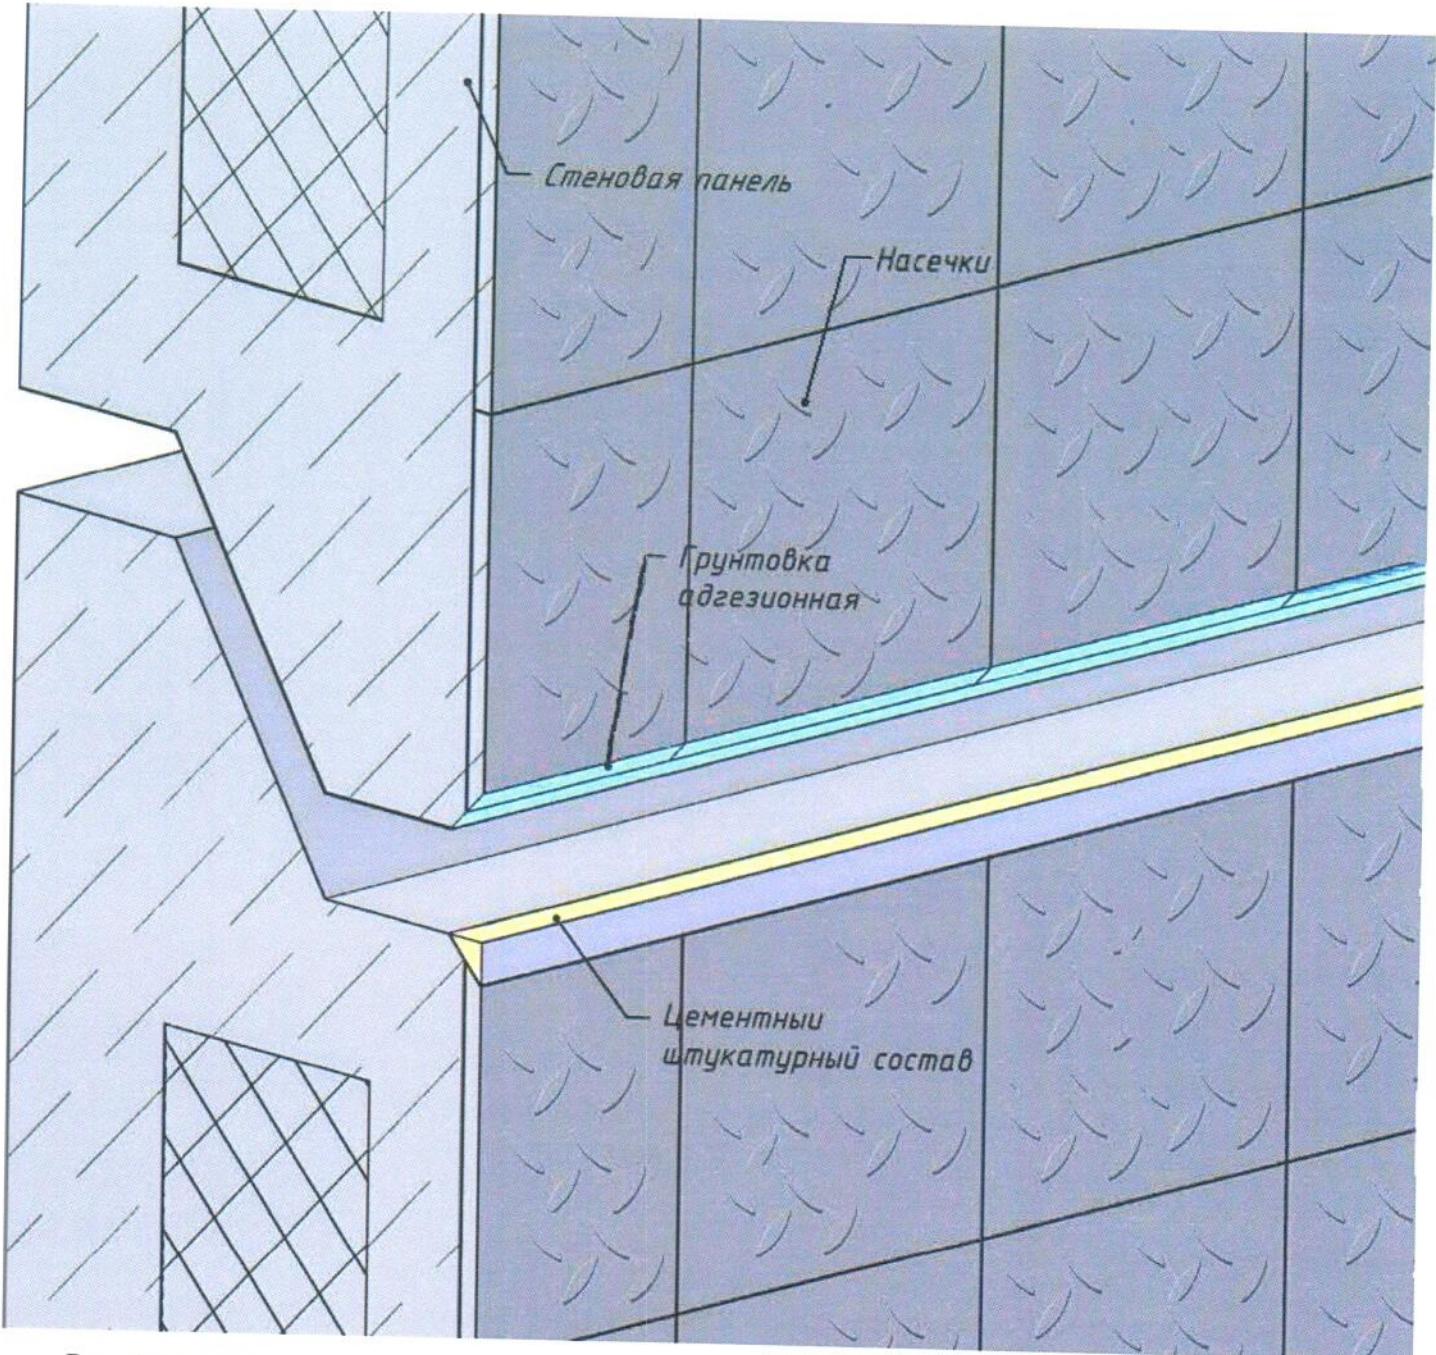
Расшивка и восстановление геометрии швов стеновых панелей. Устройство насечек на поверхности керамической плитки
